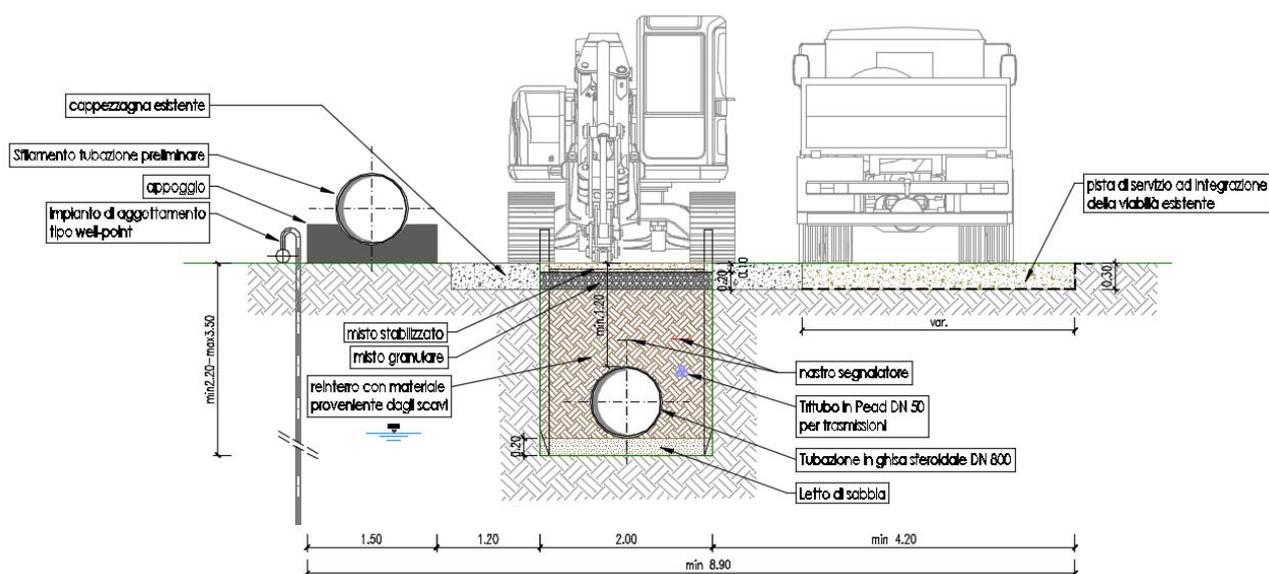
Sezione tipo 2 di scavo e di posa su strada bianca.
